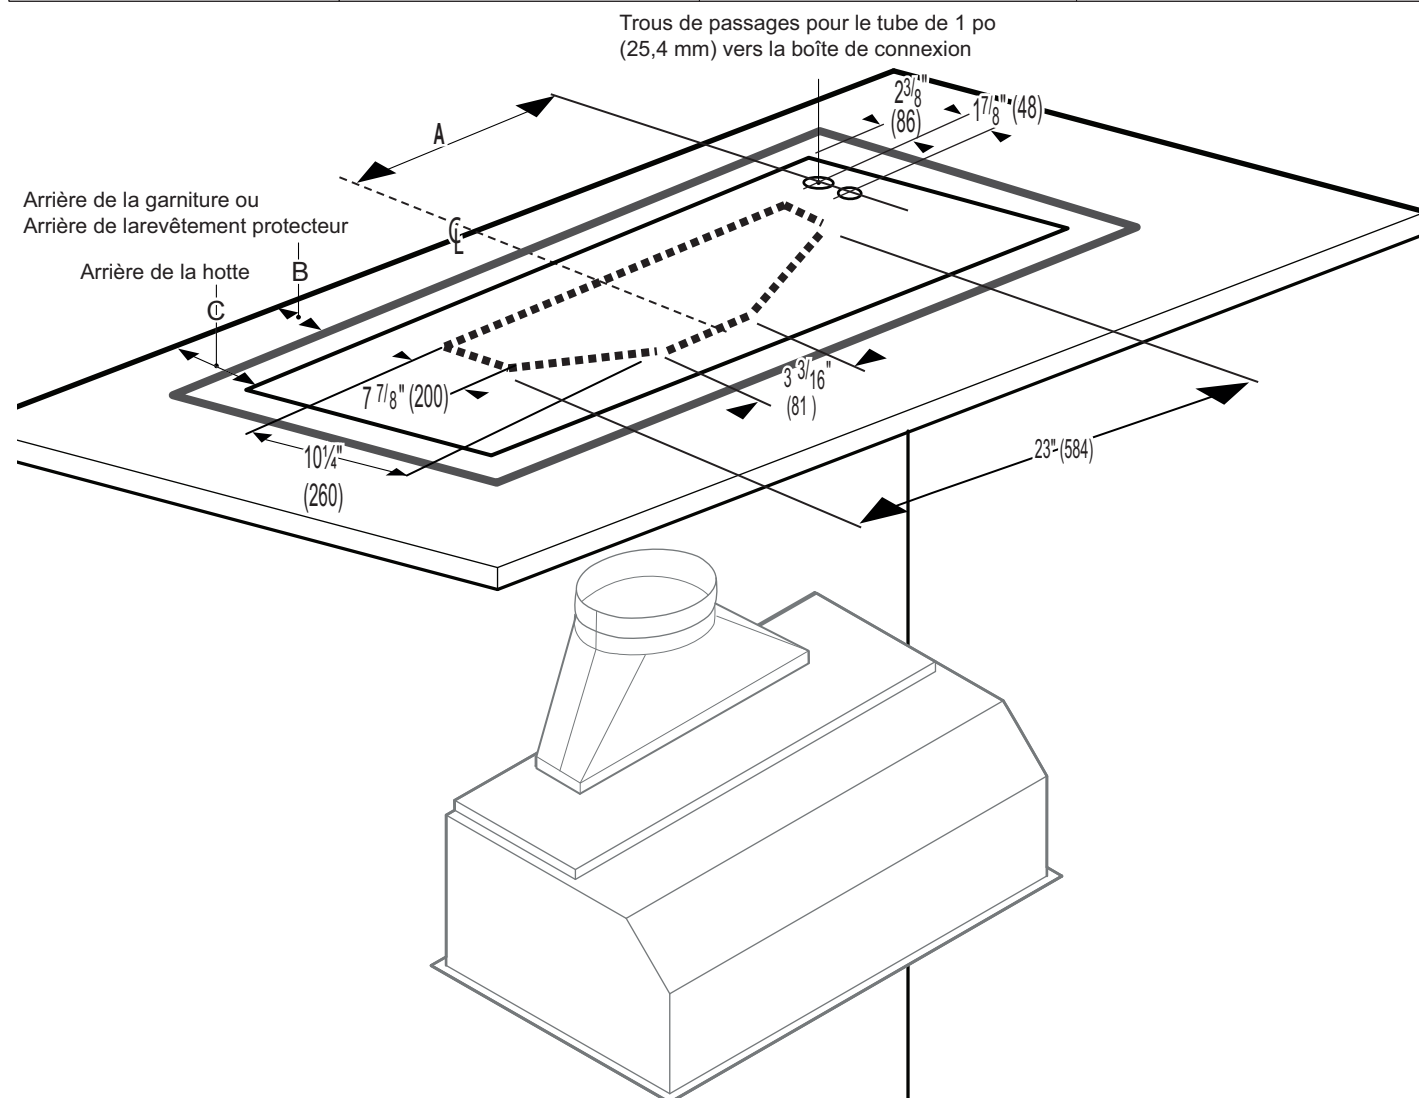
Dimensions des ouvertures pour le raccord et le tube
